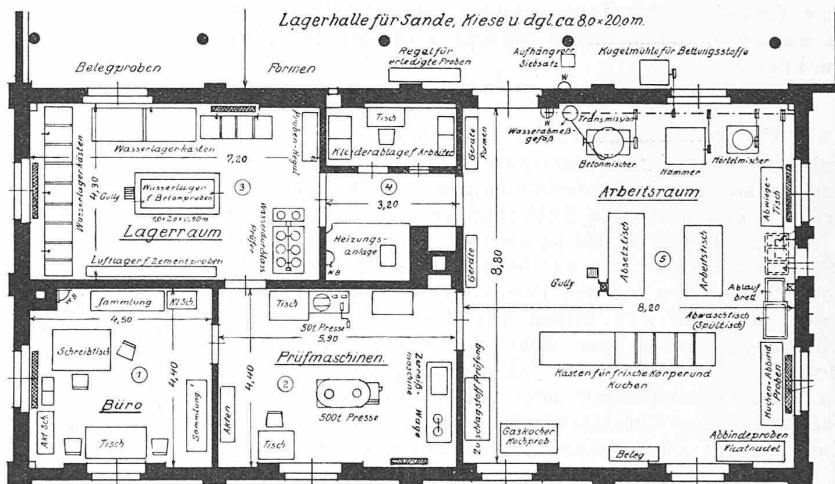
Grundriss einer Prüfstelle für Betonkontrolle. — Masstab etwa 1 : 175.
